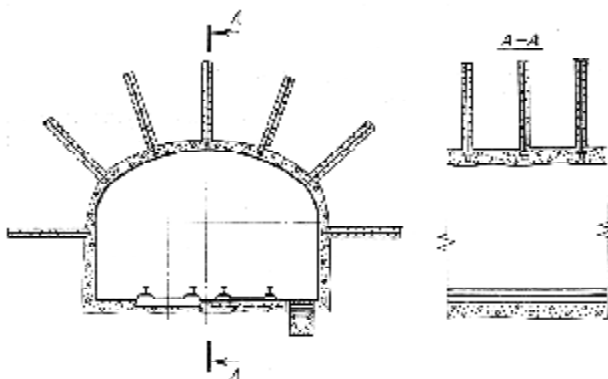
Комбіноване кріплення із набризкбетону та анкерів
